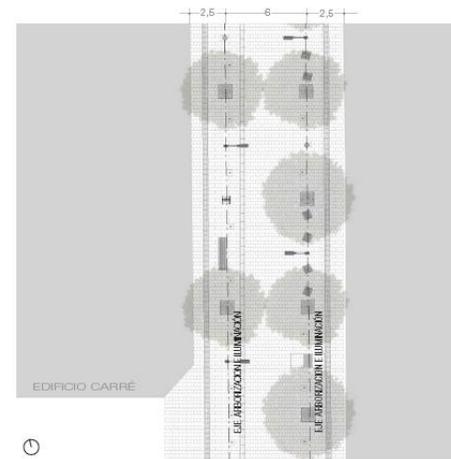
Distribución en planta de los elementos y ejes de la intervención del Paseo Urbano Carabobo T1B.
